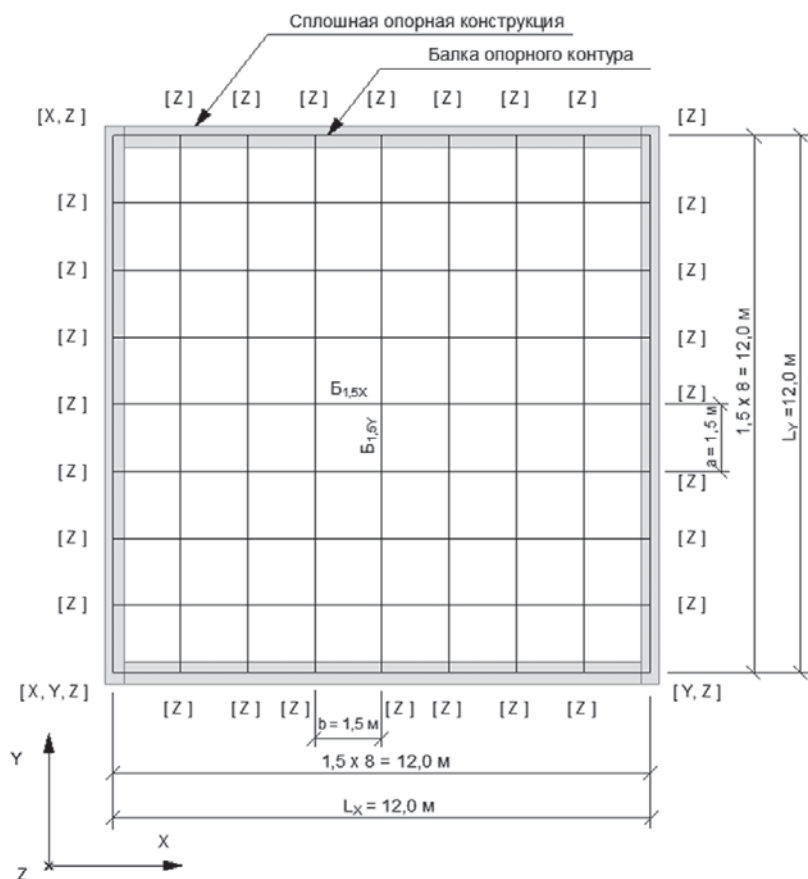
Схема кессонного перекрытия размером в плане 12,0 × 12,0 м с кессонами 1,5 × 1,5 м.
